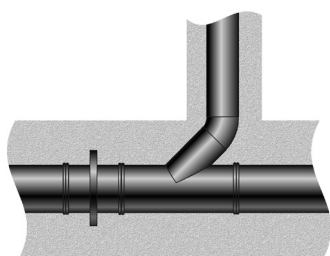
Fissaggio nel calcestruzzo con una colletto di fissaggio.
